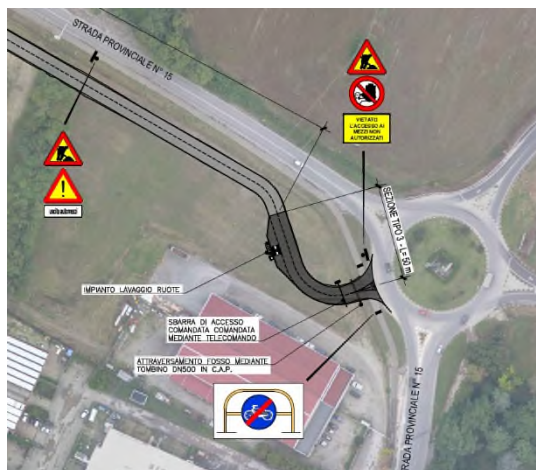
Rappresentazione planimetrica della FASE 1
